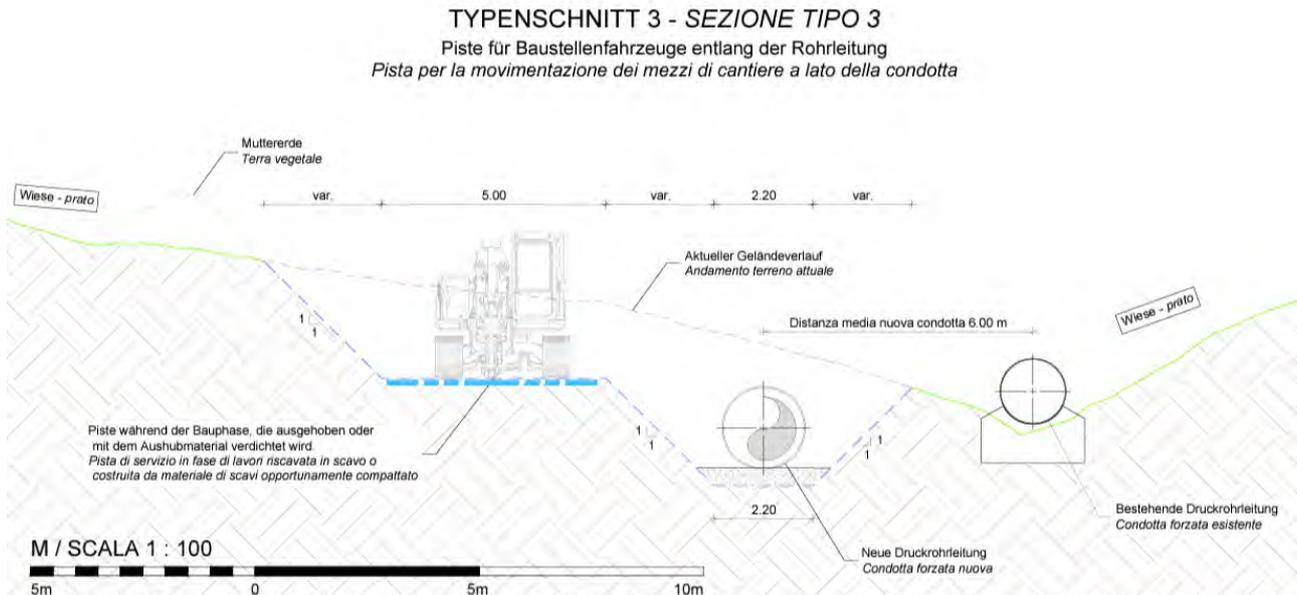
Sezione tipo della pista per la movimentazione dei mezzi di cantiere a lato della condotta.
